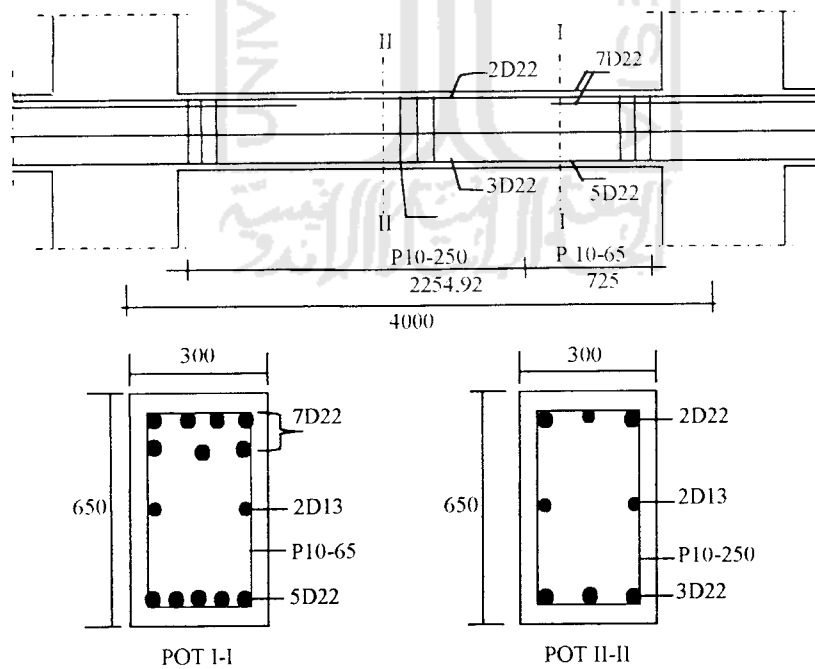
Balok Portal E Bentang 4 m Lantai 4
